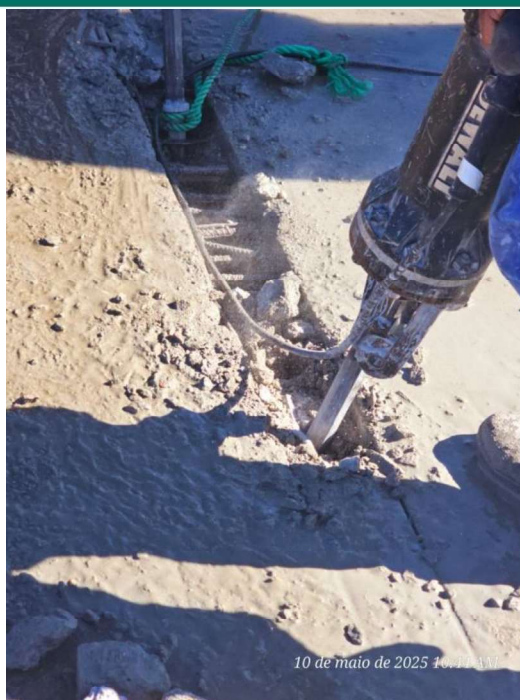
martete abrindo a junta do pilar 2 – serviço realizado no reestabelecimento
